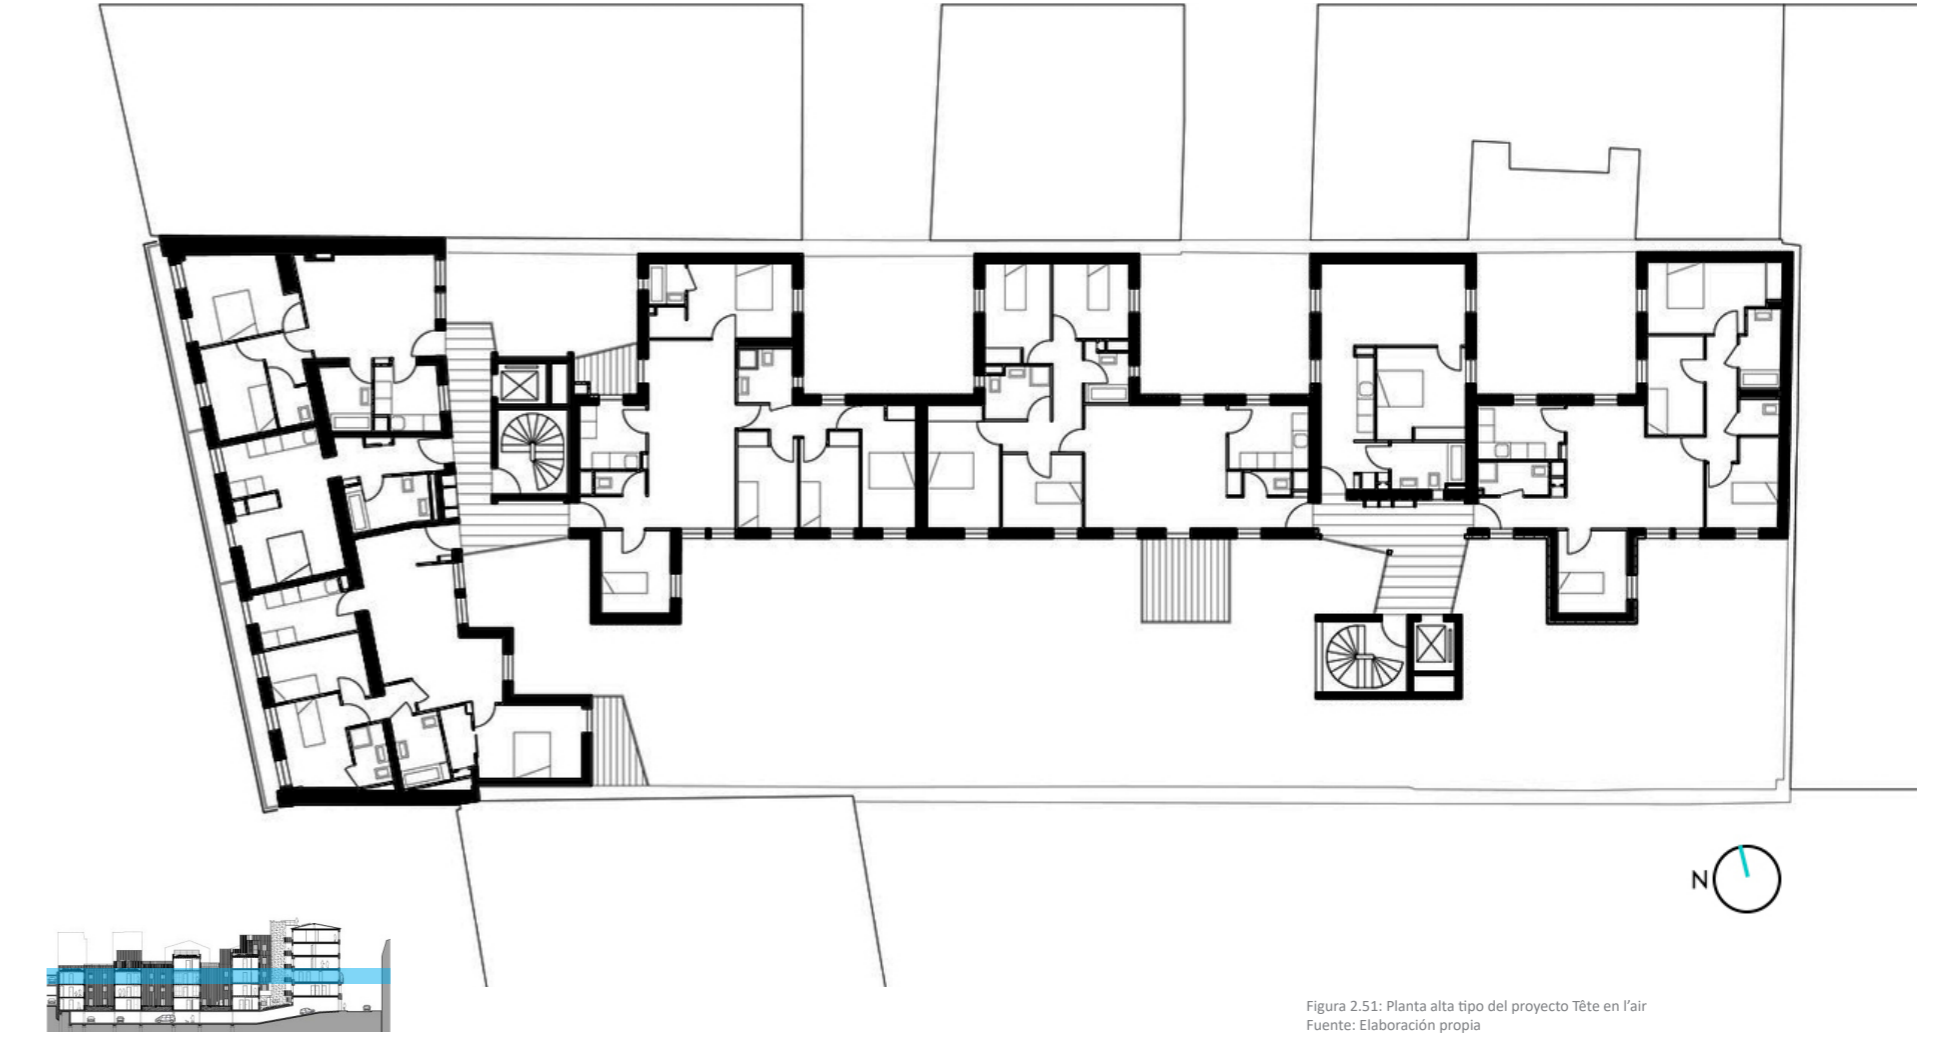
Planta alta tipo del proyecto Tête en l'air
